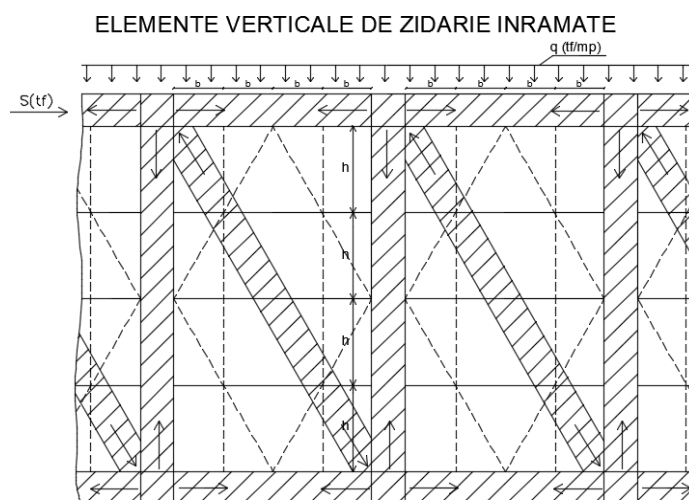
Schema elementelor verticale, orizontale și diagonale pentru un perete de zidărie cu bare verticale înglobate sau stâlpișori de beton armat legați de elemente verticale.
